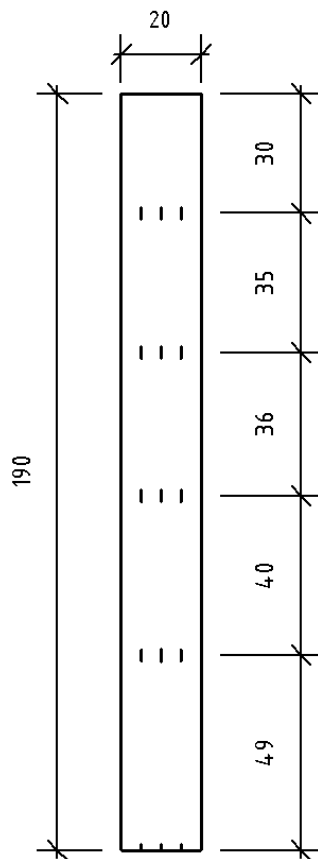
Sågning av den stora betongplattan till flera provkroppar.
